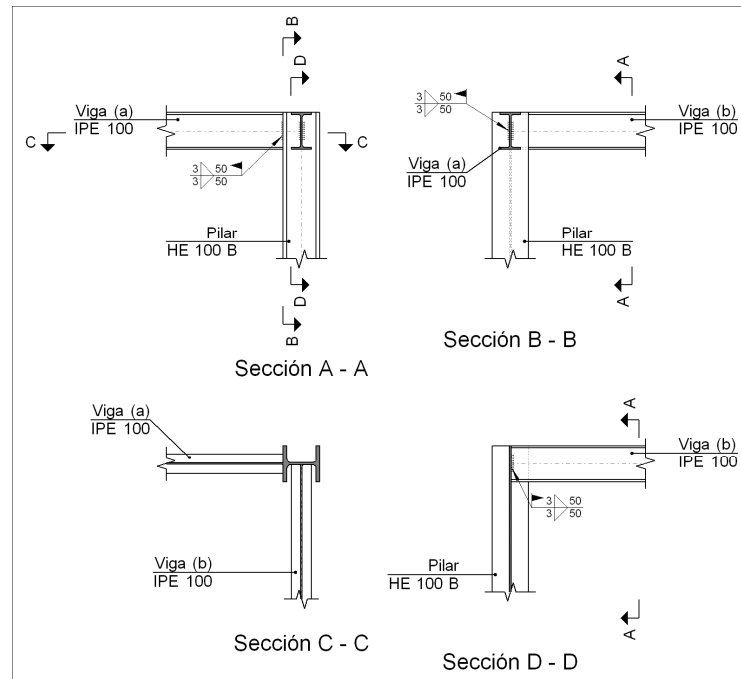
Detalle de las soldaduras tipo 4 de la estructura superior de las escaleras
